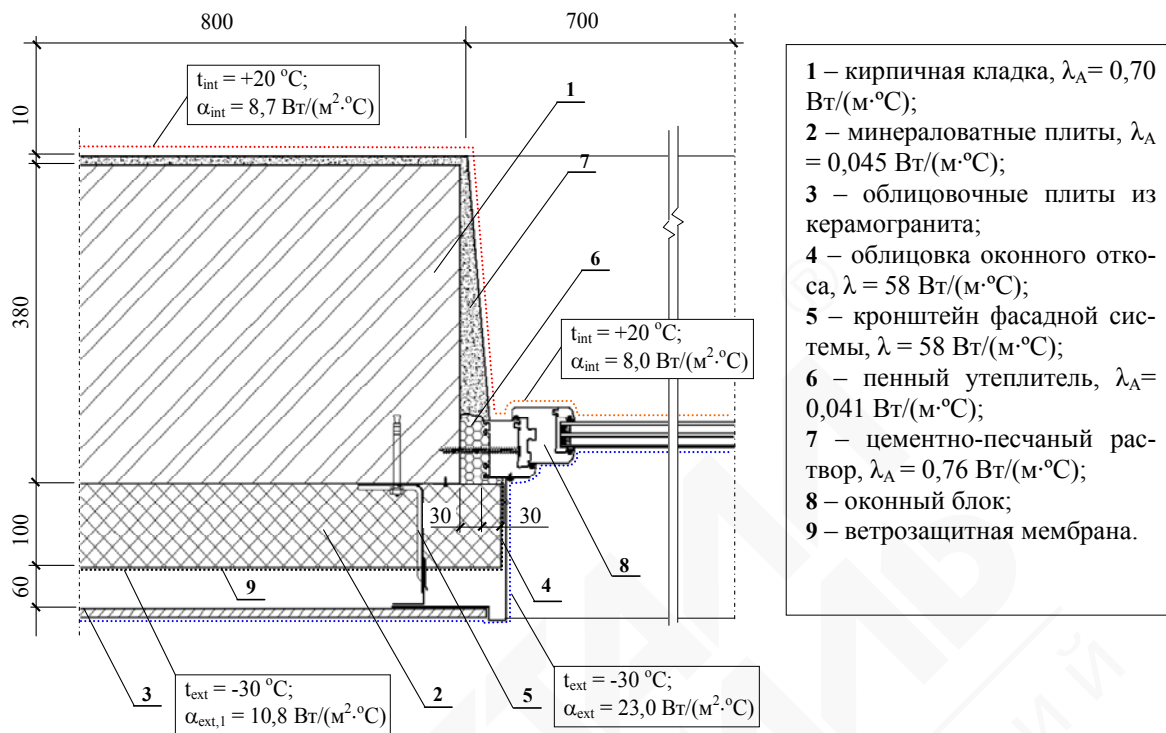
Расчетная схема узла сопряжения наружной стены с навесной фасадной системой «ВФ МП» о оконным блоком из ПВХ-профилей
